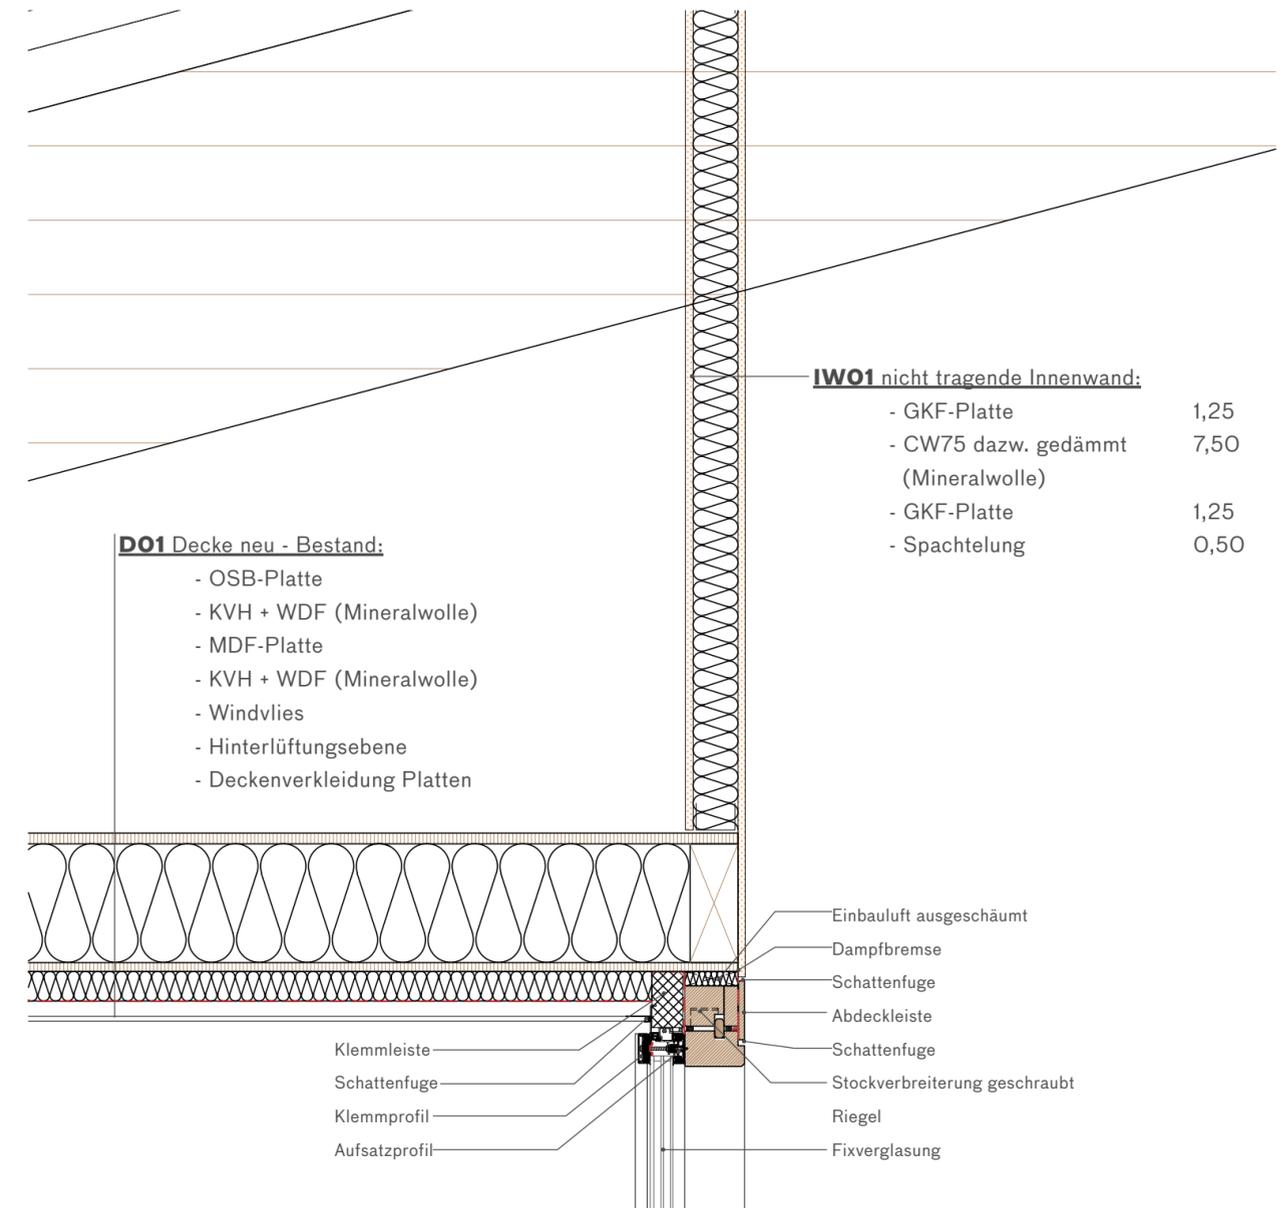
Detail oberer Anschluss Eingangsportal Umbau Bestand
